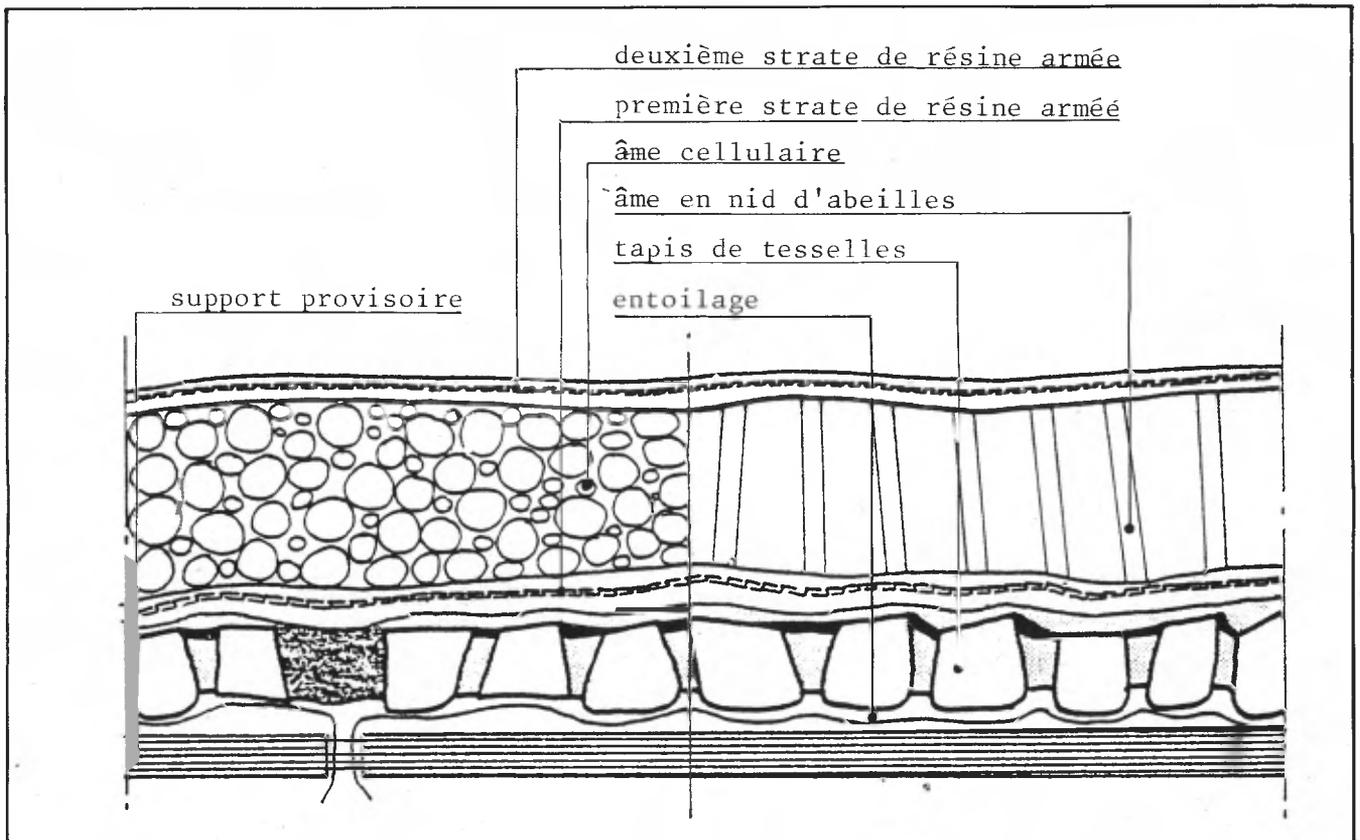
Sandwich fabriqué sur la face arrière de la mosaïque.
